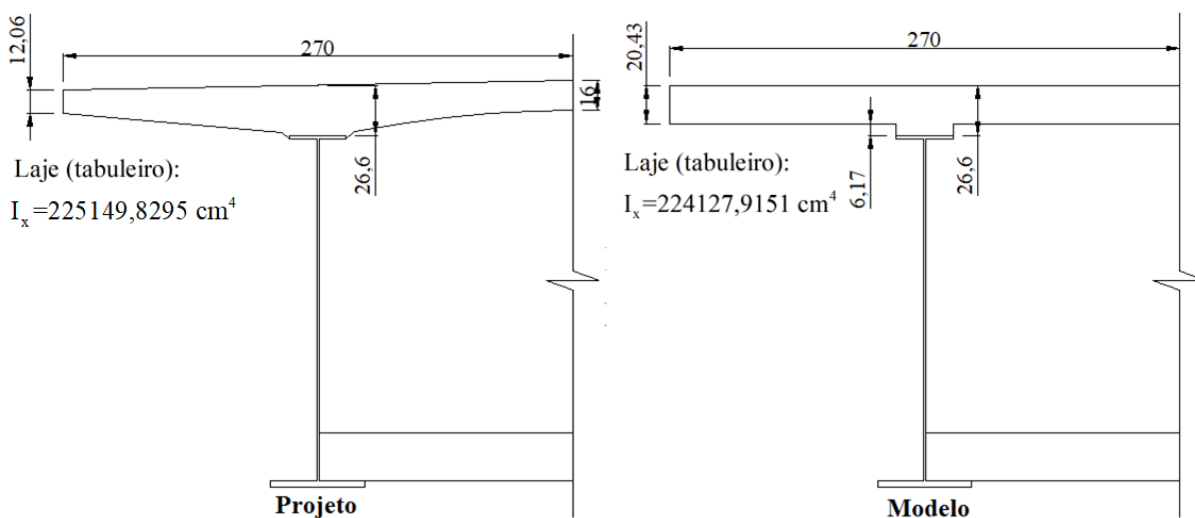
Seção transversal – viga única – unidade em cm.
